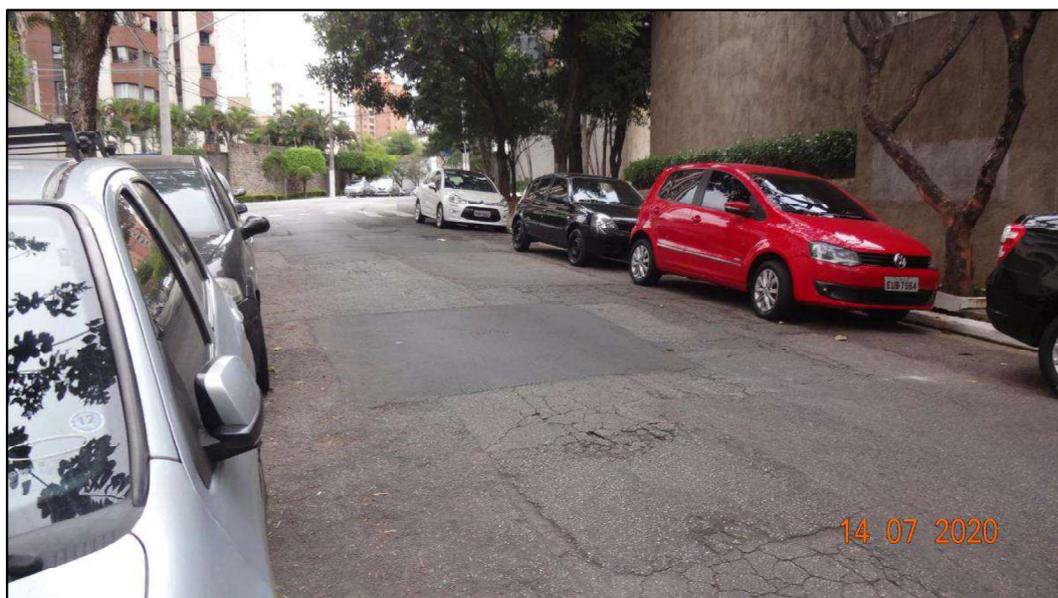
Outra vista da Rua João Alves dos Santos, no trecho onde se situa o imóvel avaliando.
